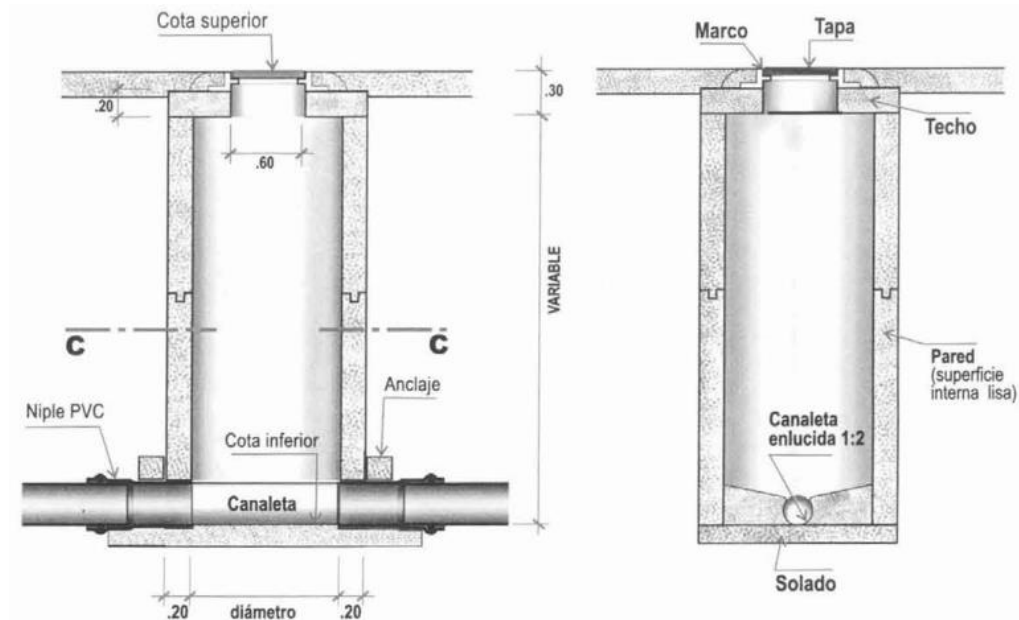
Corte longitudinal y transversal de una cámara de inspección
